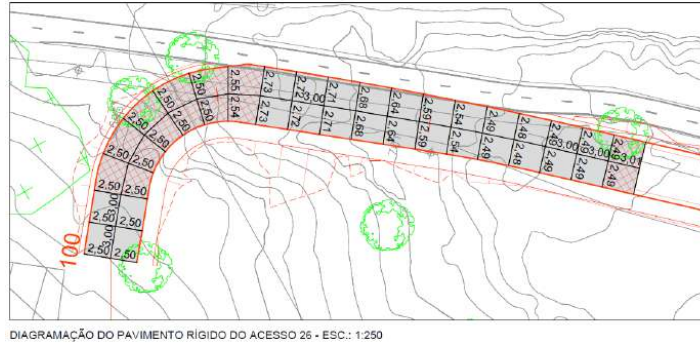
Diagrama do pavimento rígido do acesso nº26.
